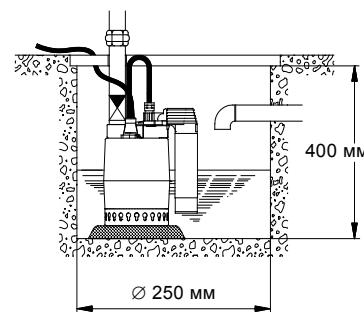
Мин. размеры резервуара для Unilift KP-AV
